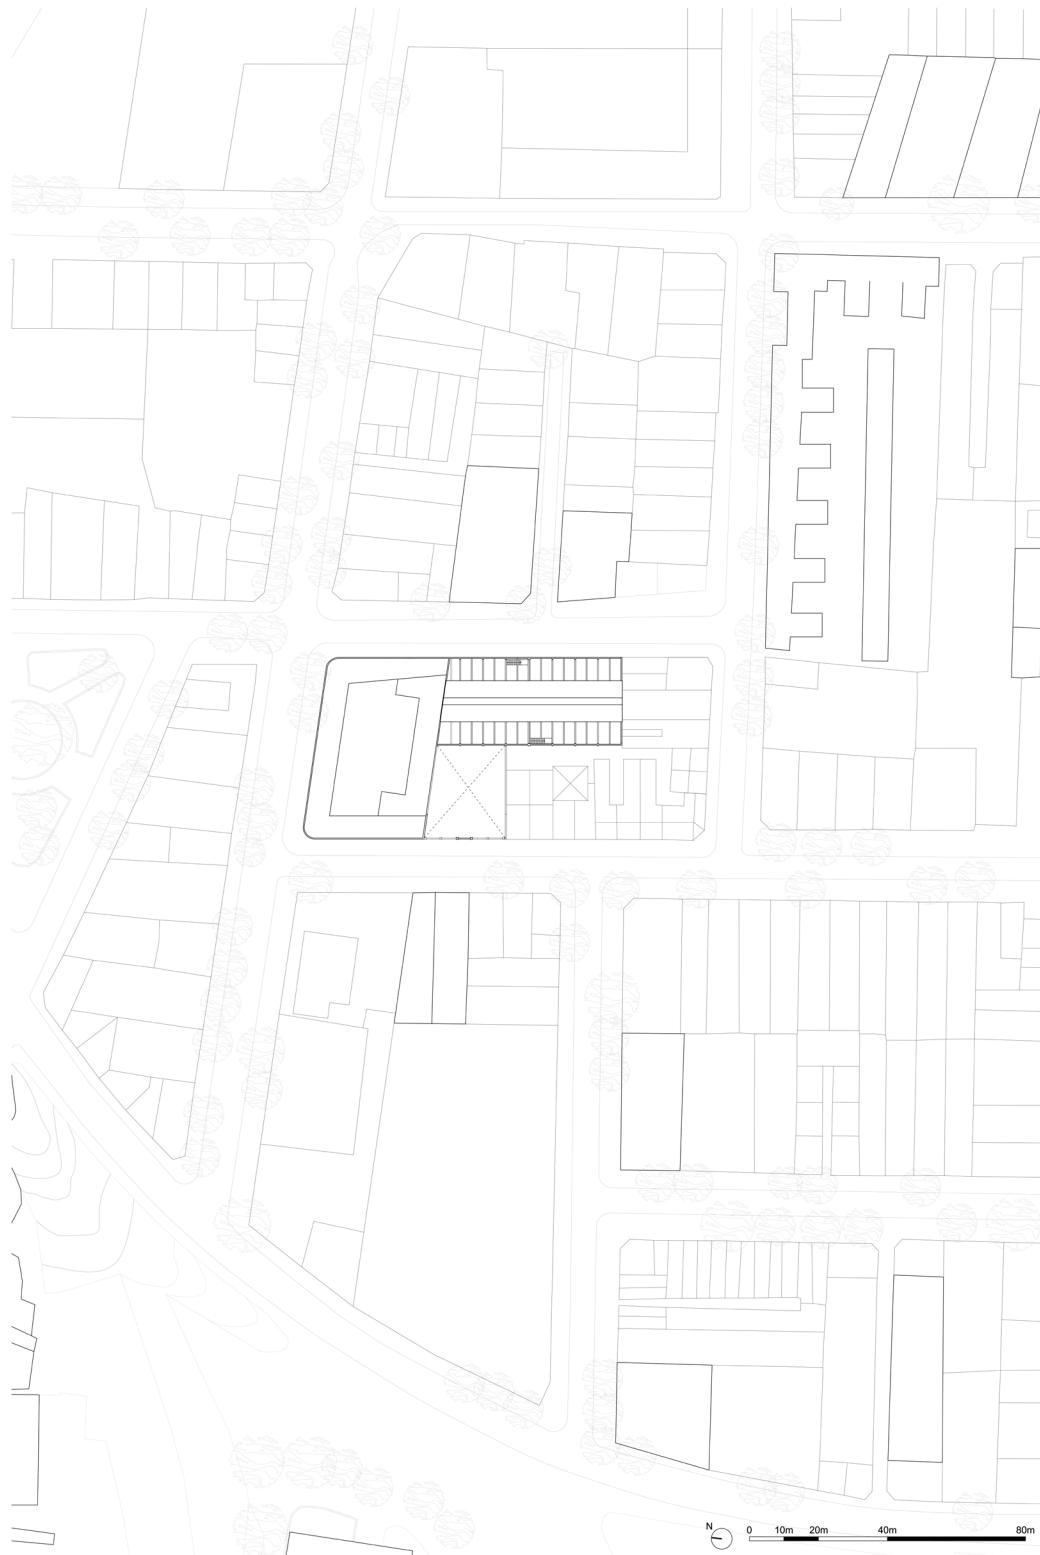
Plano emplazamiento Ex Fundación Metalco. Fuente: elaboración propia.
